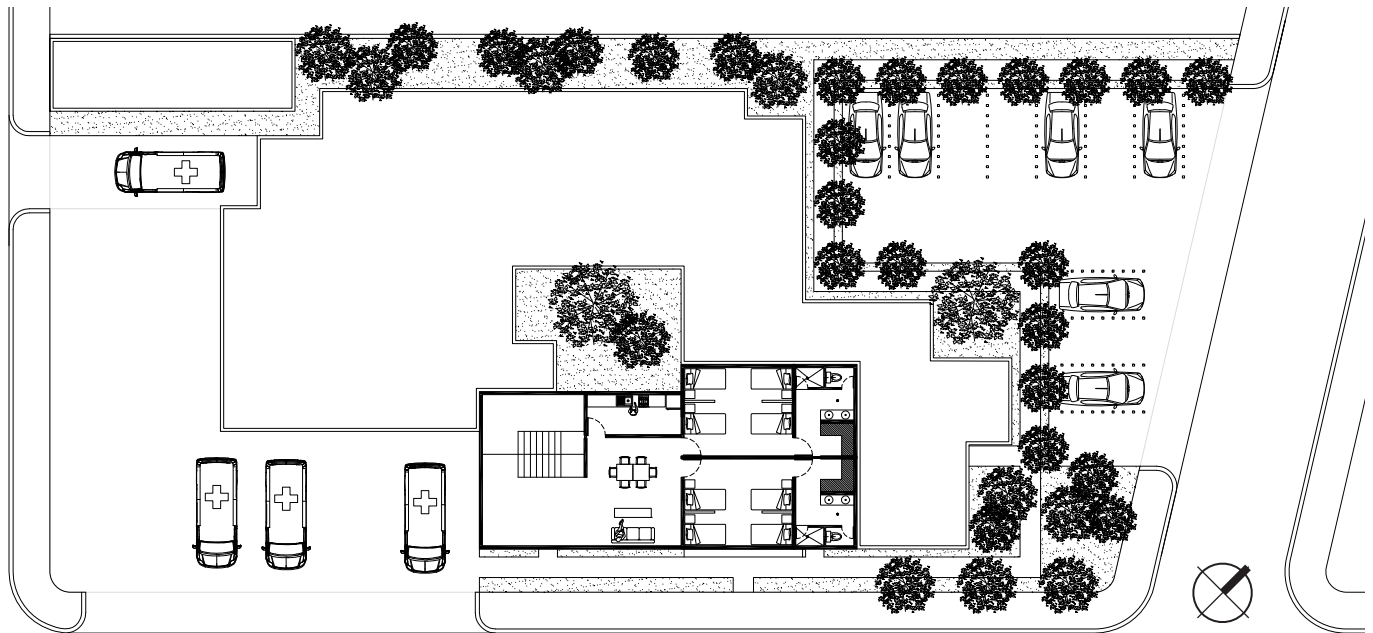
| Prototipo Delegación Media para el grupo climático tres | Planta Baja
